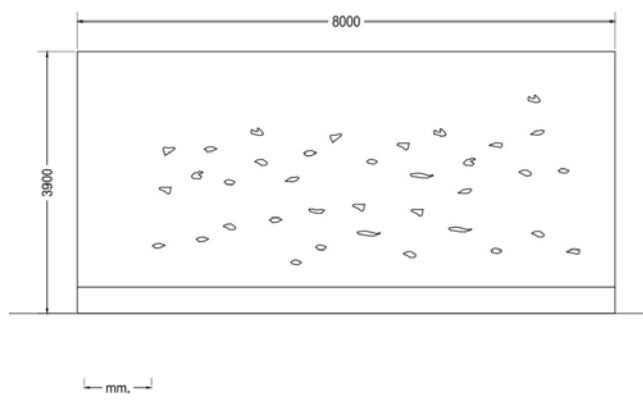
Elemento Muro de Escalada finalizado. Fuente: propia
